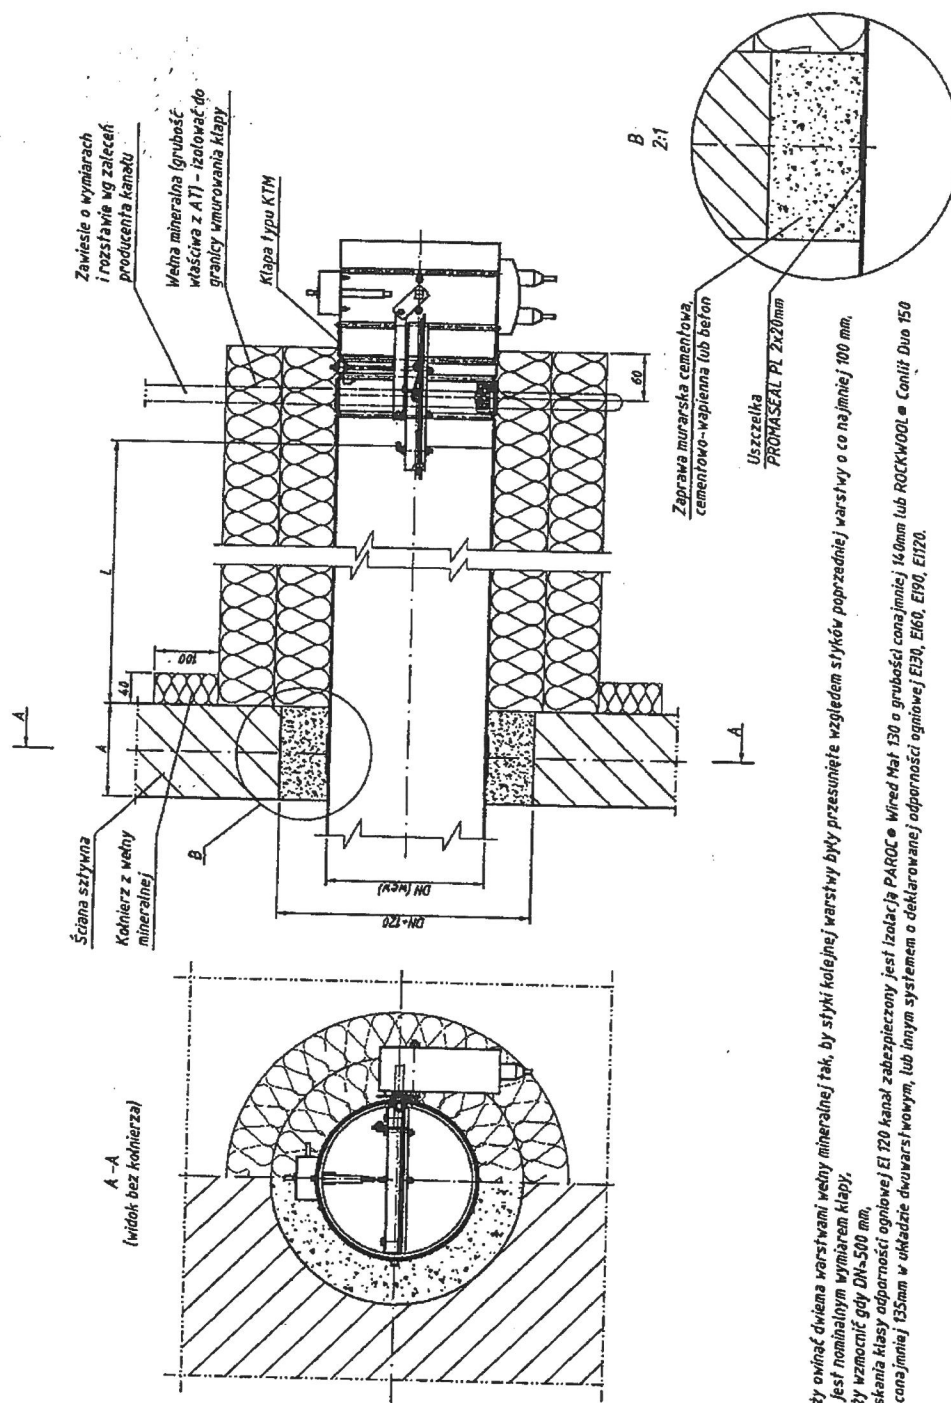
Montaż klapy KTM-nypel w ścianach betonowych i murowanych
